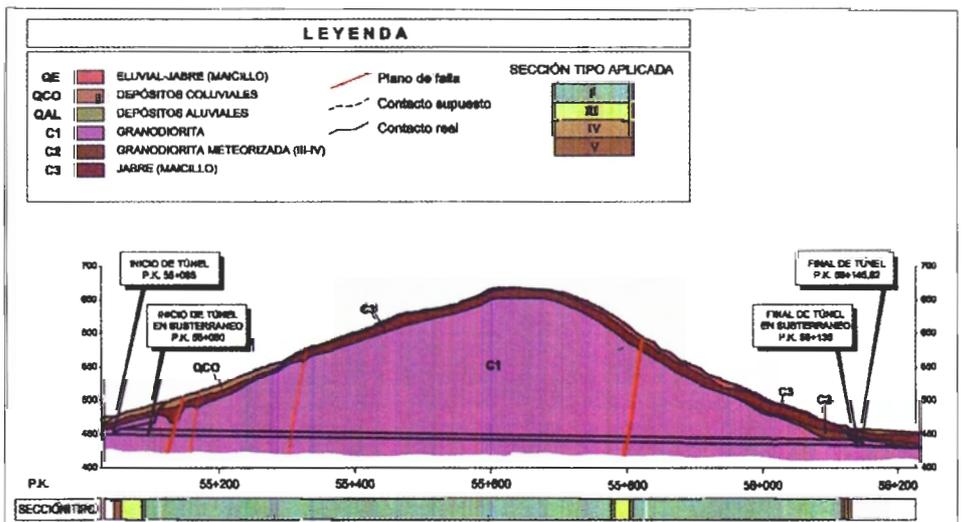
Perfil longitudinal del túnel Zapata II.
